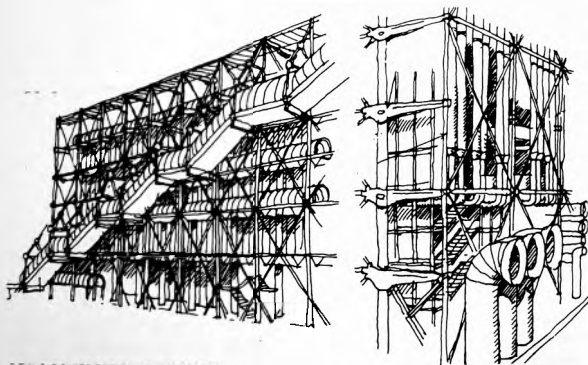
Centro Georges Pompidou / Beaubourg : Piano e Rogers
